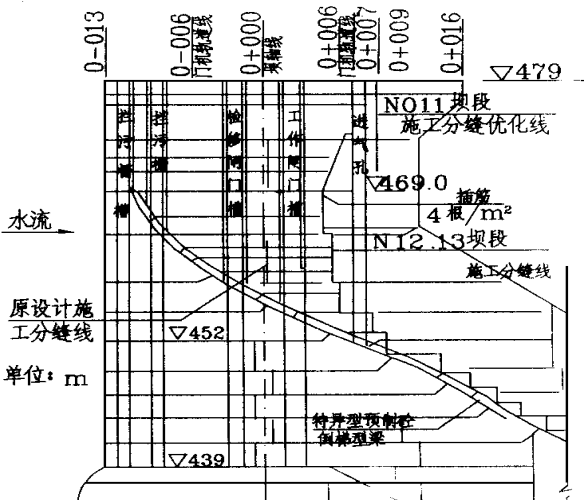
厂坝进水口混凝土施工缝分缝优化示意图
